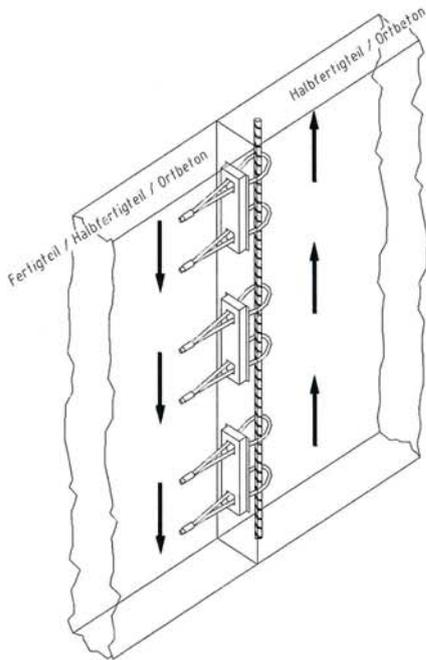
Beanspruchung parallel zur Fugenlängsrichtung
